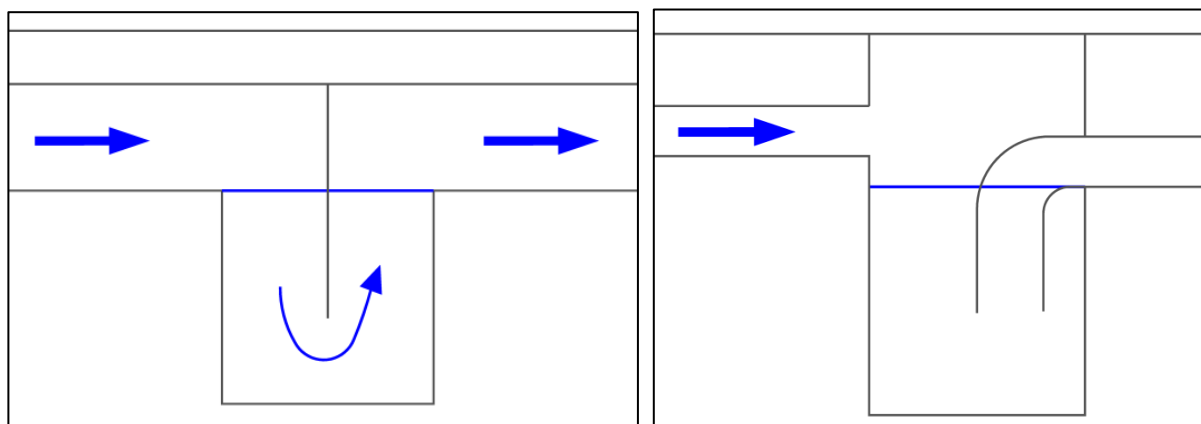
Schémas de principe de 2 exemples de zones de décantation (cloison siphonoïde et coude PVC)
